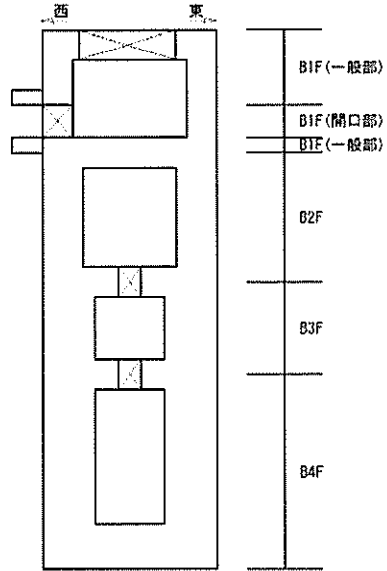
(1) 概略配筋図 (東西方向断面)
